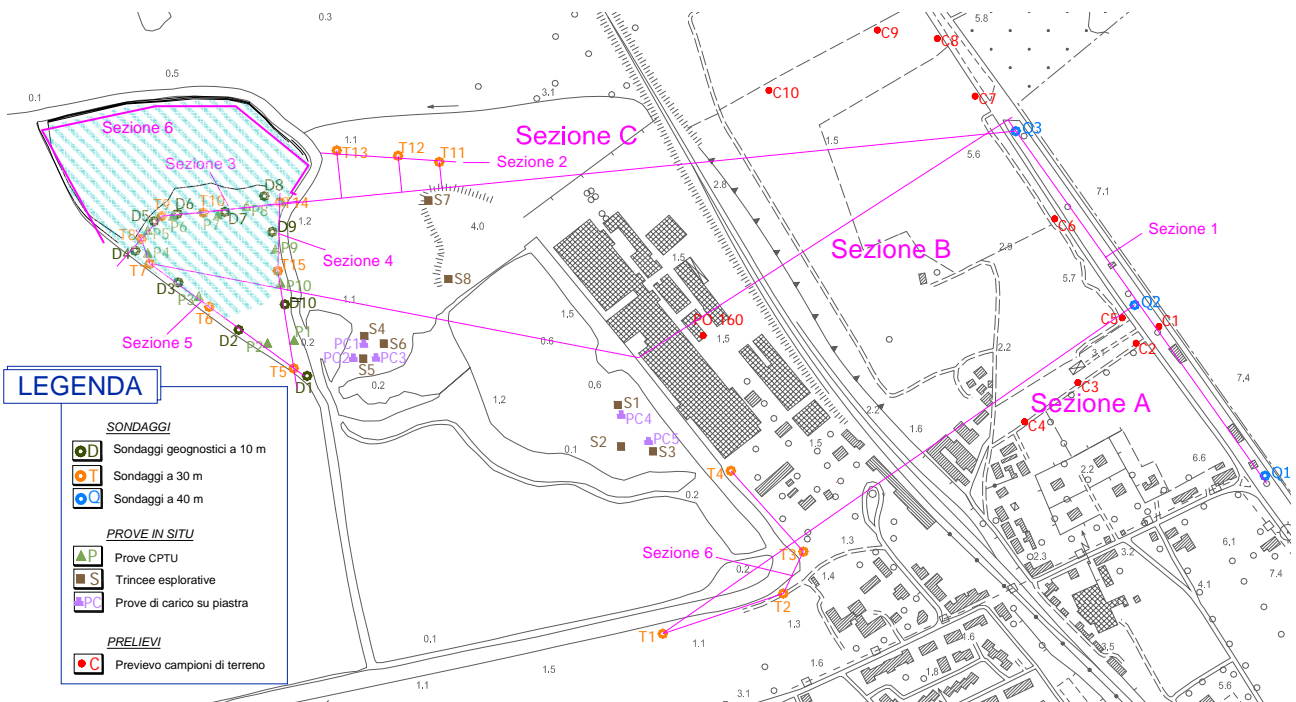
planimetria generale con indicazione del perimetro della cassa di colmata di "Pian dell'Asca".
